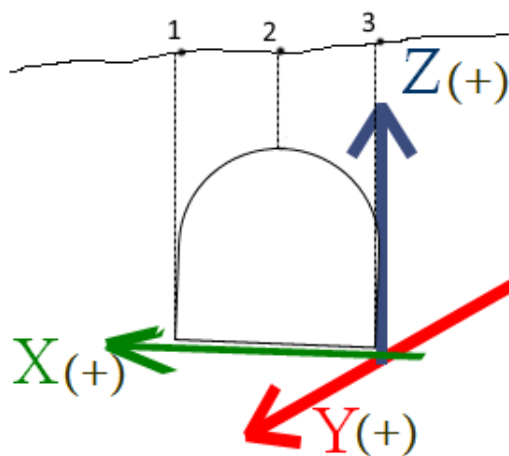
Secção transversal PK 0+652 - localização dos dispositivos de instrumentação
